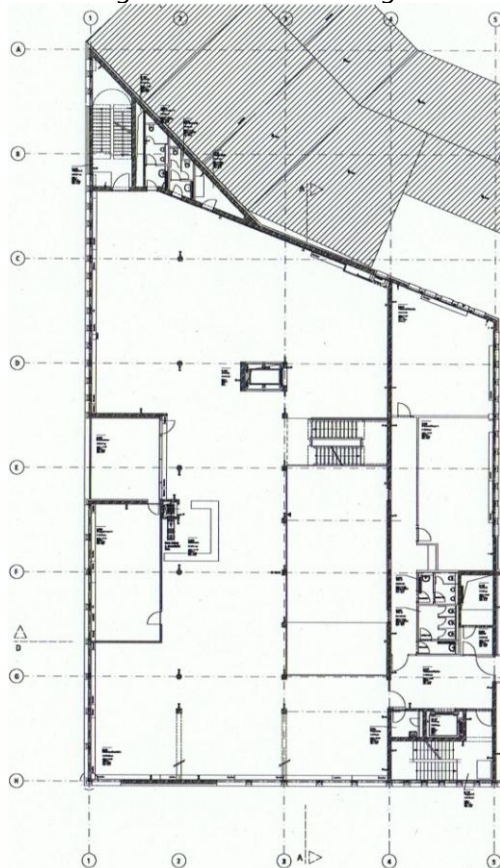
Grundriss 3.Obergeschoss Zentralbibliothek Hamm
